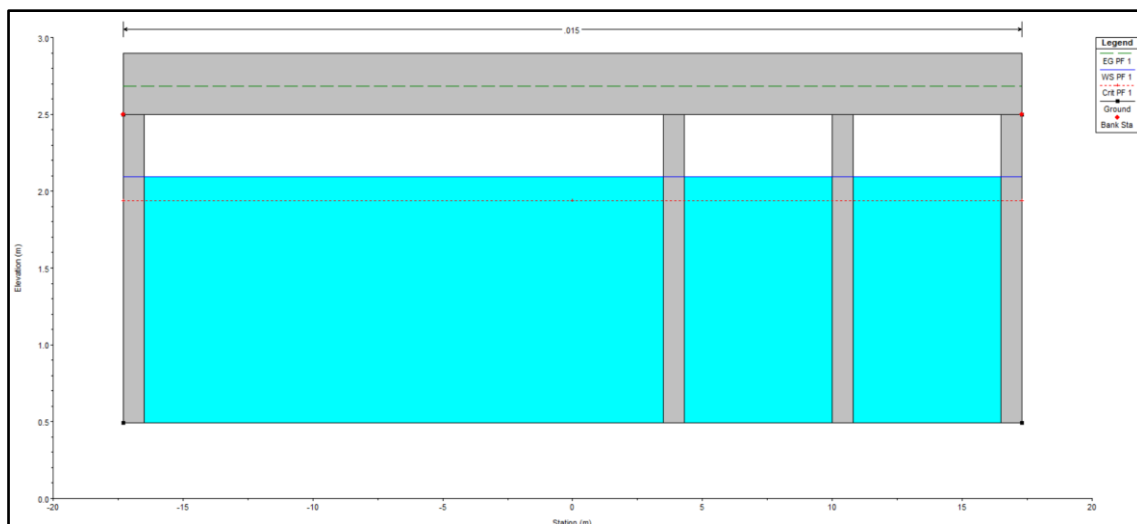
Sección bajo puente de la carretera de Las Marinas.
